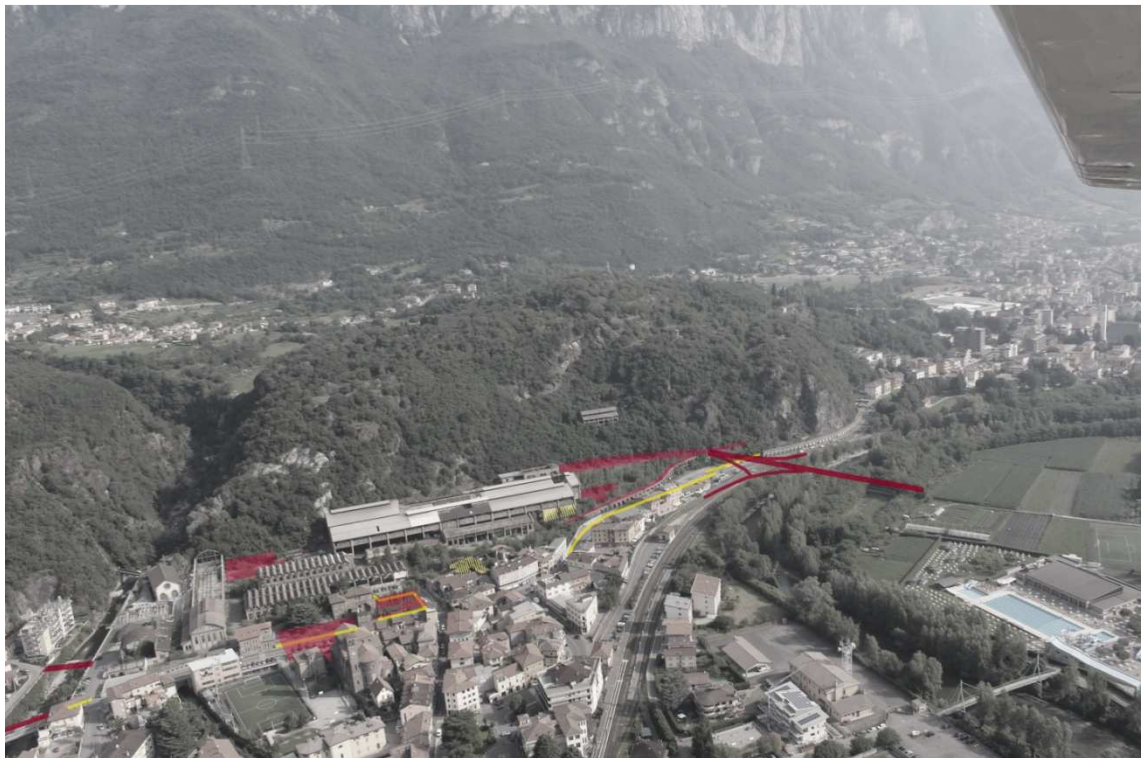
Schema demolizioni e ridefinizione e costruzione di progetto
